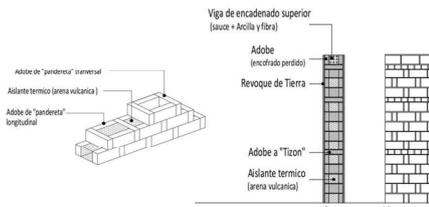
(izq.). Detalle constructivo de la pared de adobe "enuhacalado" | Imagen de "Debarro Arquitectura"
